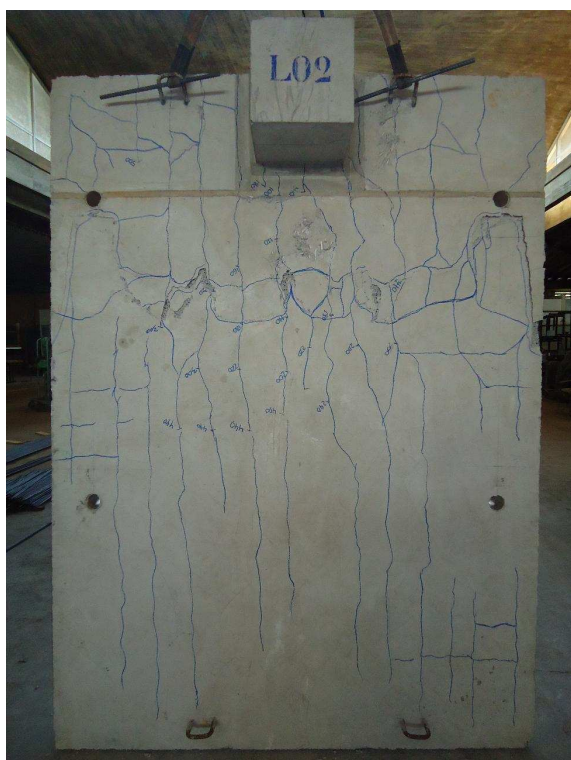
Padrão de fissuração da face superior da laje – L2
